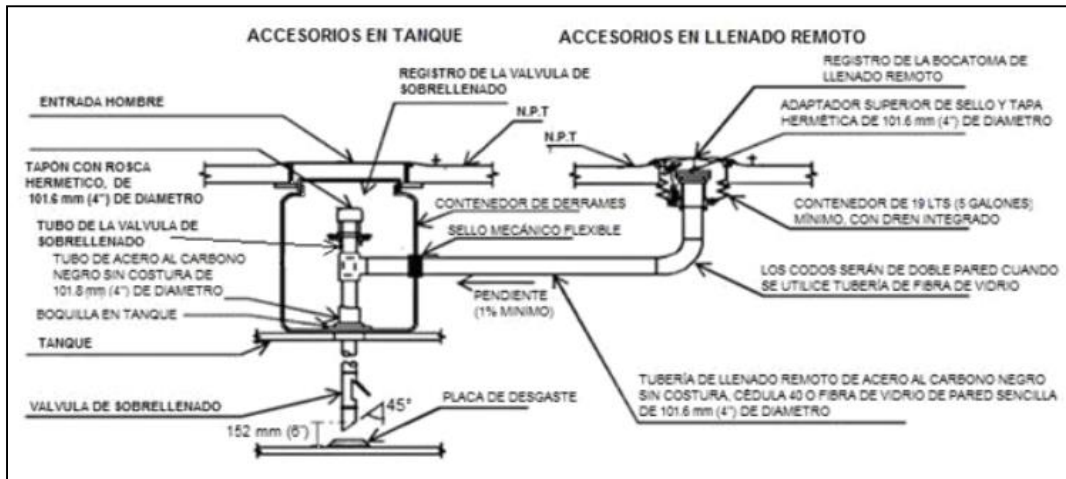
Accesorios y componentes con que debe contar los tanques de almacenamiento.
